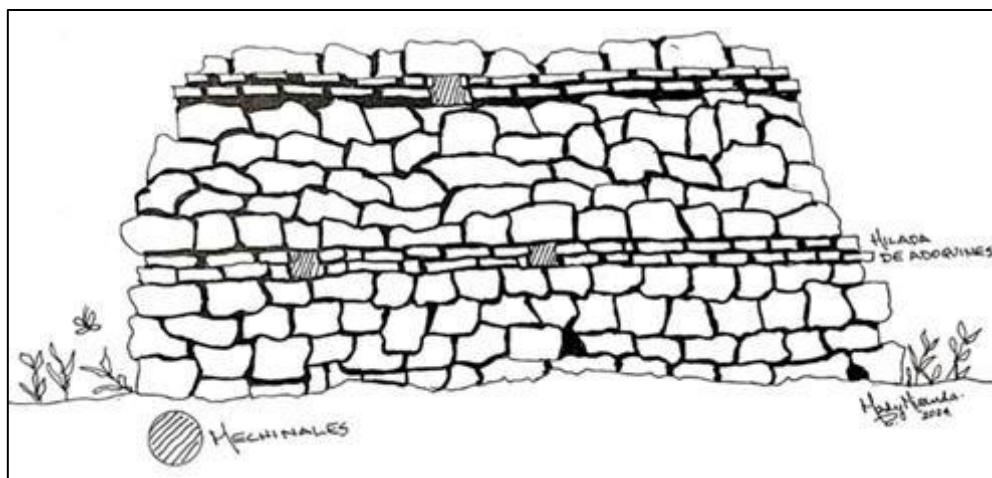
Esquema libre que ejemplifica la colocación de hiladas de adoquines en los muros de mampostería de Panamá Viejo. (Elaborado por la autora, 2024).
